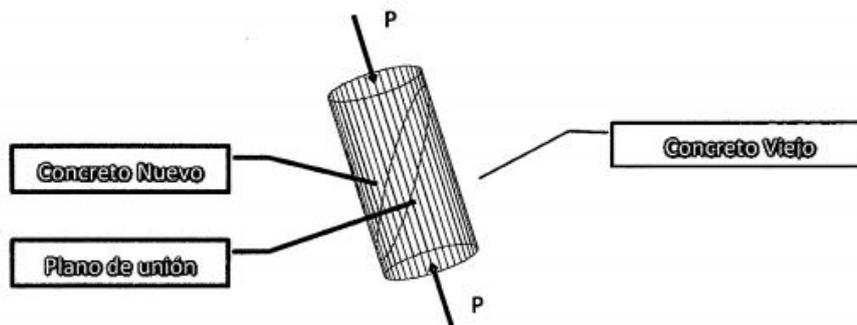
Modelo de probeta con junta de Lechada Cementicia
